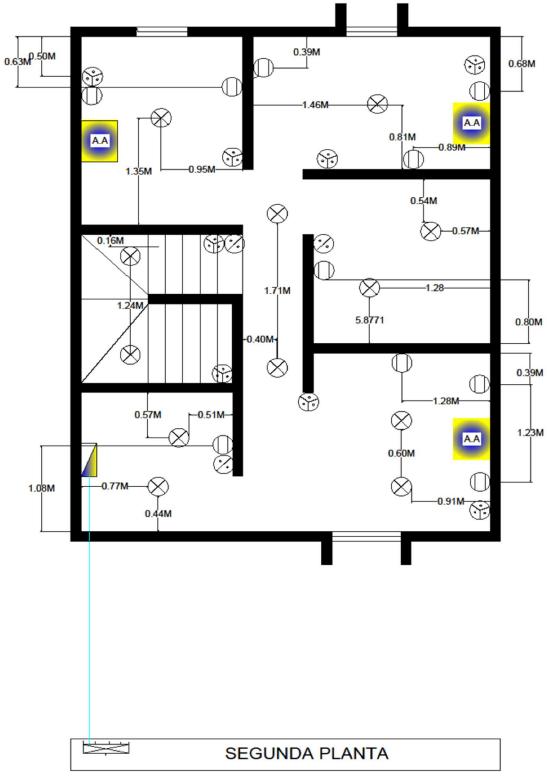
Plano de distribución eléctrica de la segunda planta.
